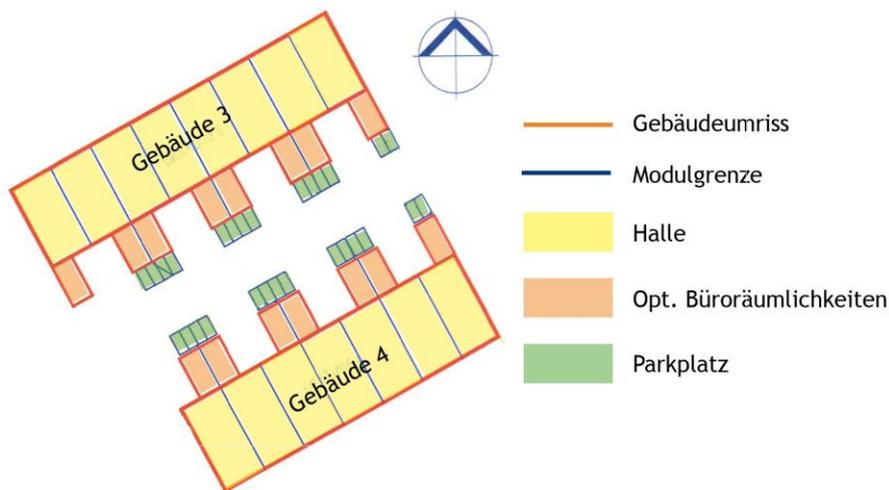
Grundriss Gebäude 3 & 4 (Quelle: Technisches Büro DI Bienert KG - Bestandsplan Gewerbepark Wienerstraße 114 GmbH , eigene Bearbeitung)
